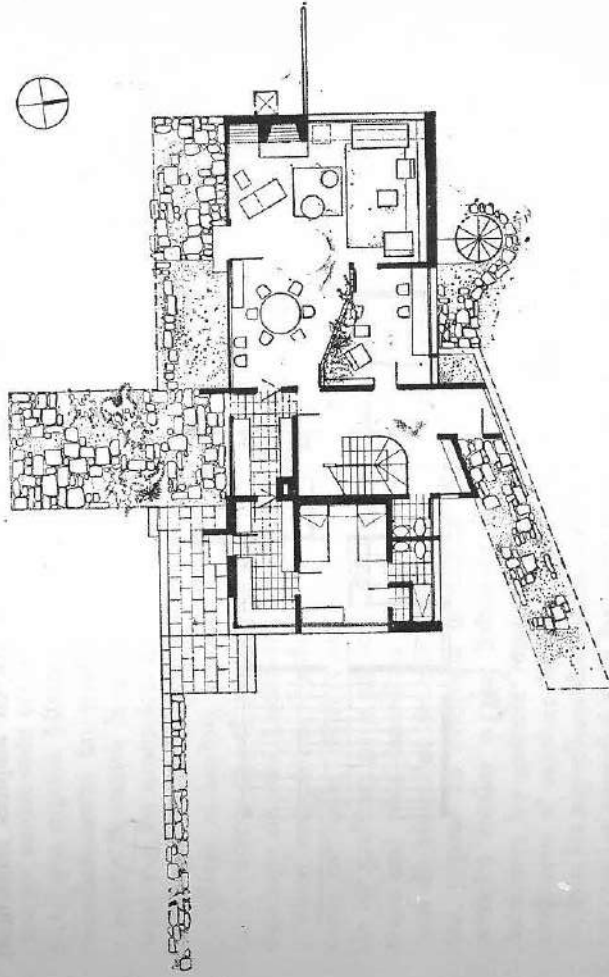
Walter Gropius: Casa en Lincoln, Mass. Planta baja. Escala 1:250.
